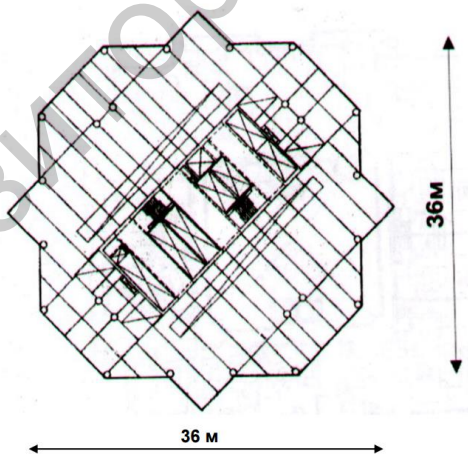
План жилого здания с трубобетонными колоннами в г. Мельбурне, Австралия
